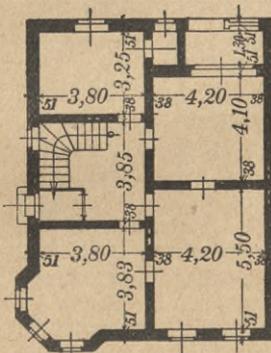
Erdgeschoß-Grundriß zu Abb. 143 a.
